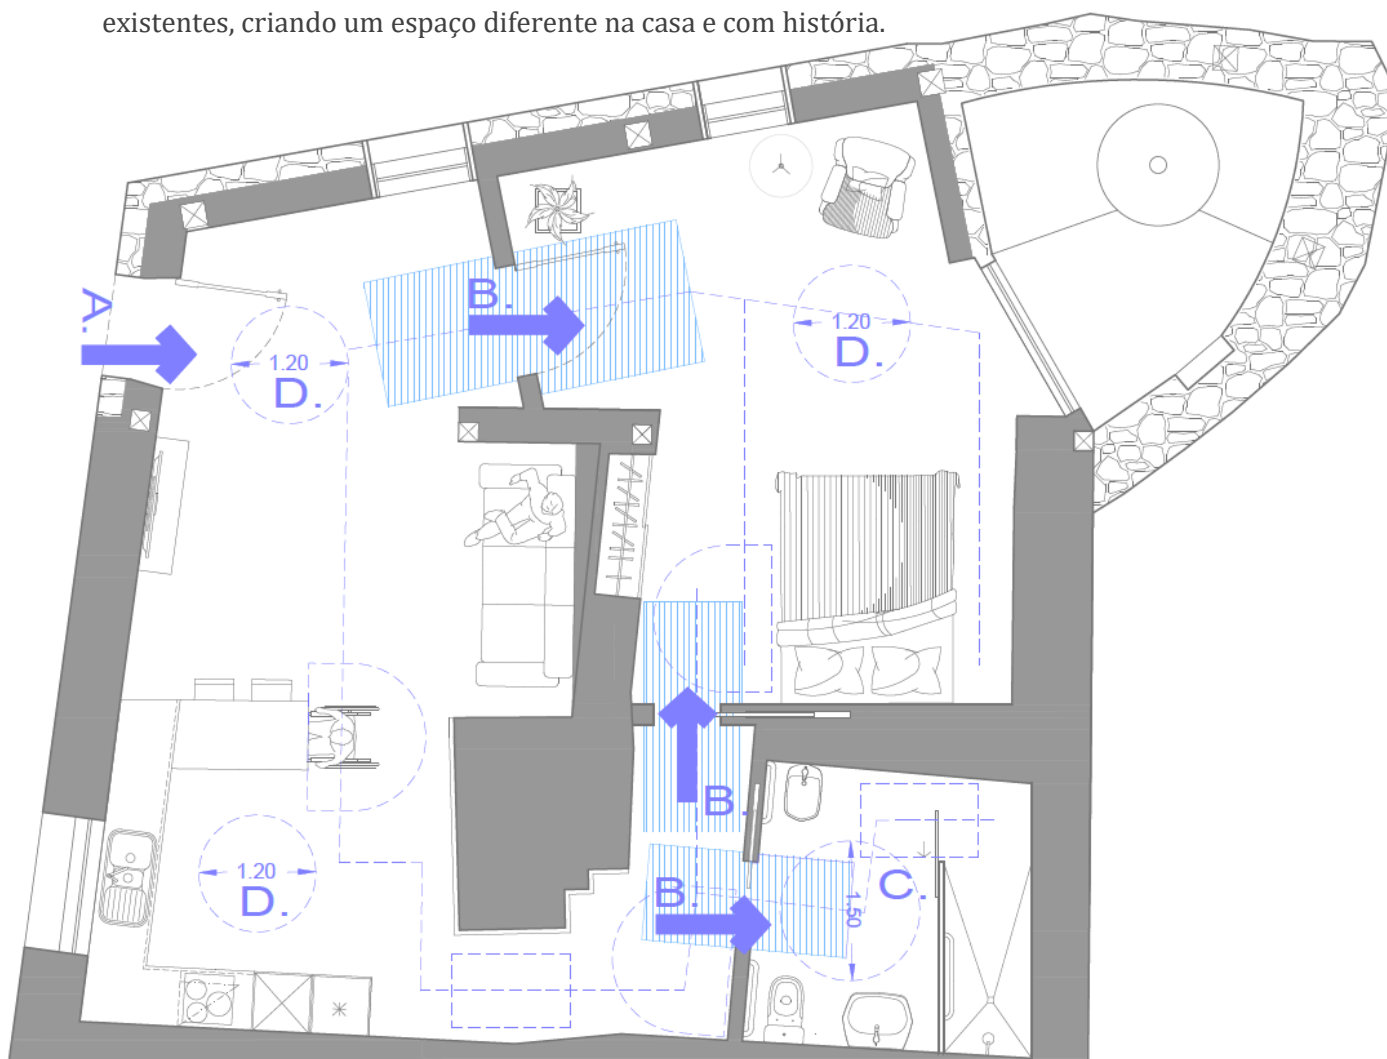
Casa 1: Planta de Acessibilidades – R/Chão. Esboço 2
